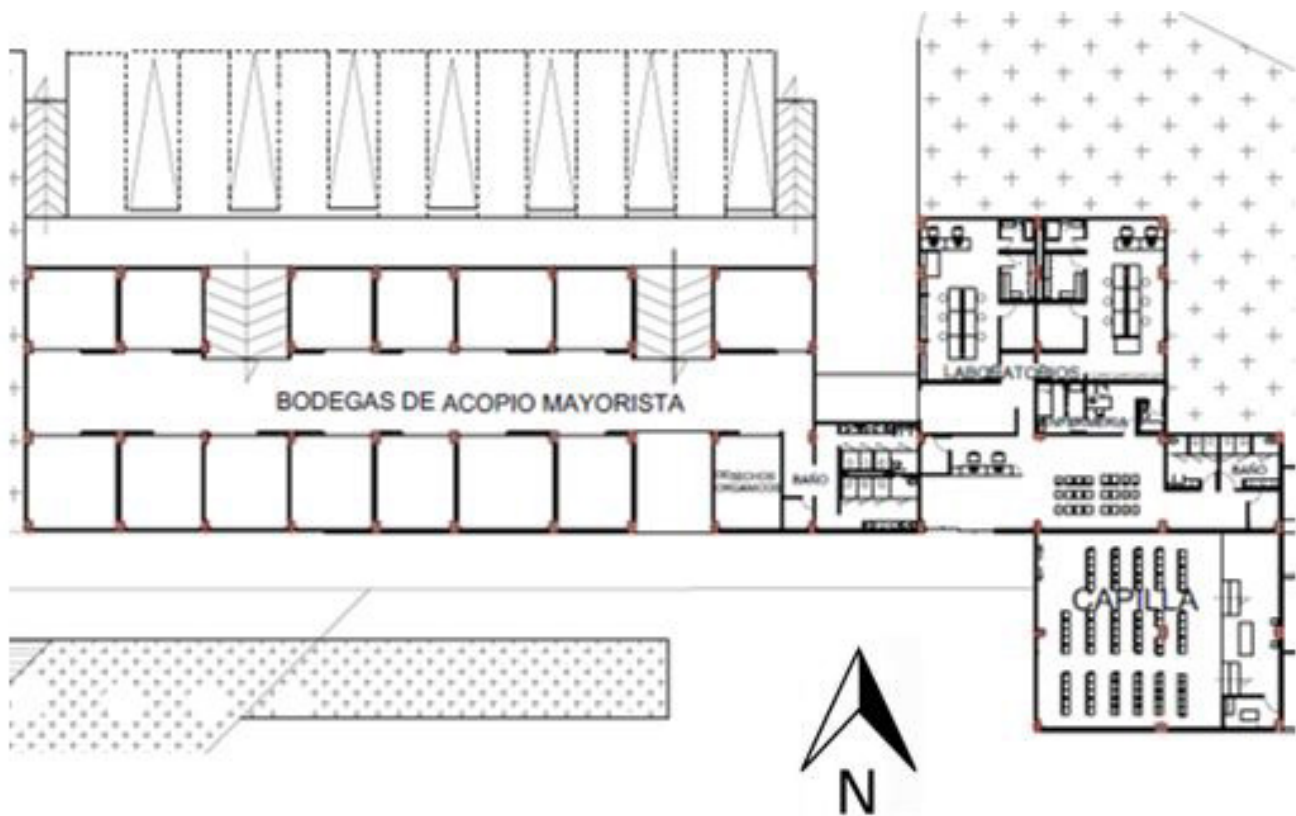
Planta primer piso Zona de Acopio, Servicios y Capilla.
